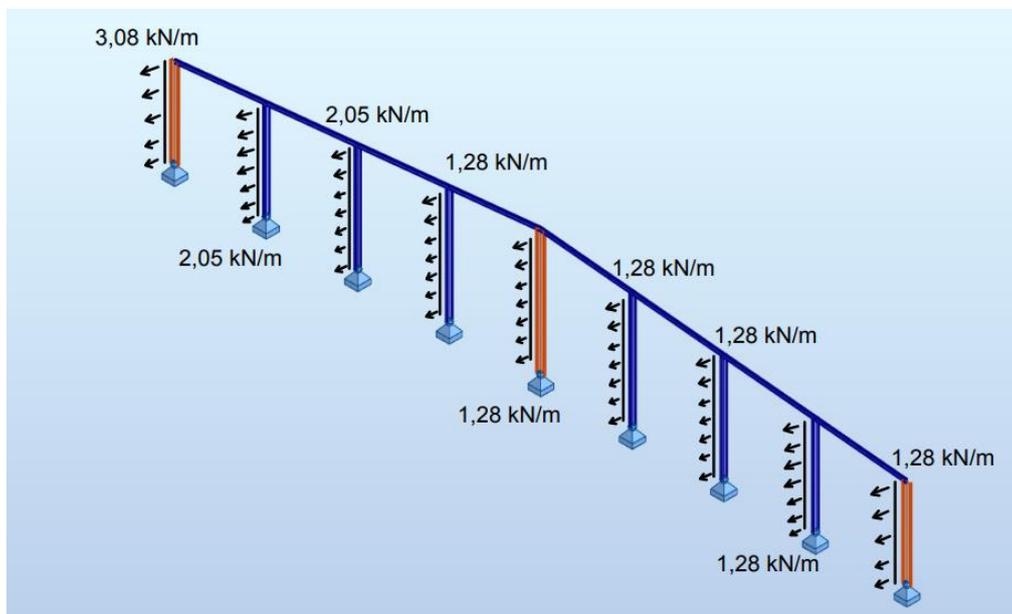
REPRESENTACIÓN CARGAS DE VIENTO EN PÓRTICO DE FACHADA (PLANO PERPENDICULAR AL PÓRTICO) CON DIRECCIÓN TRANSVERSAL A ESTA
